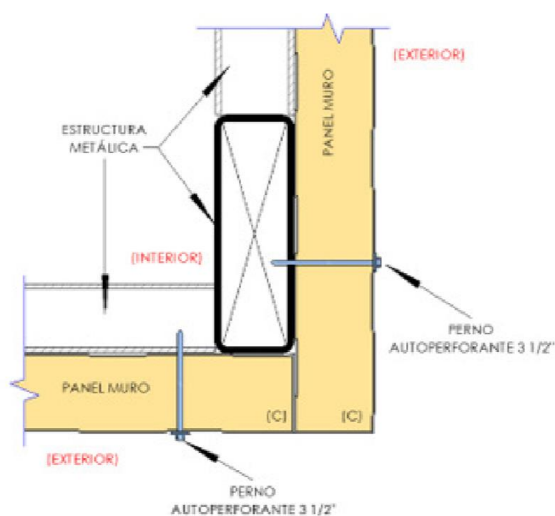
Método típico de encaje y fijación de paneles muro sándwich en esquina.
